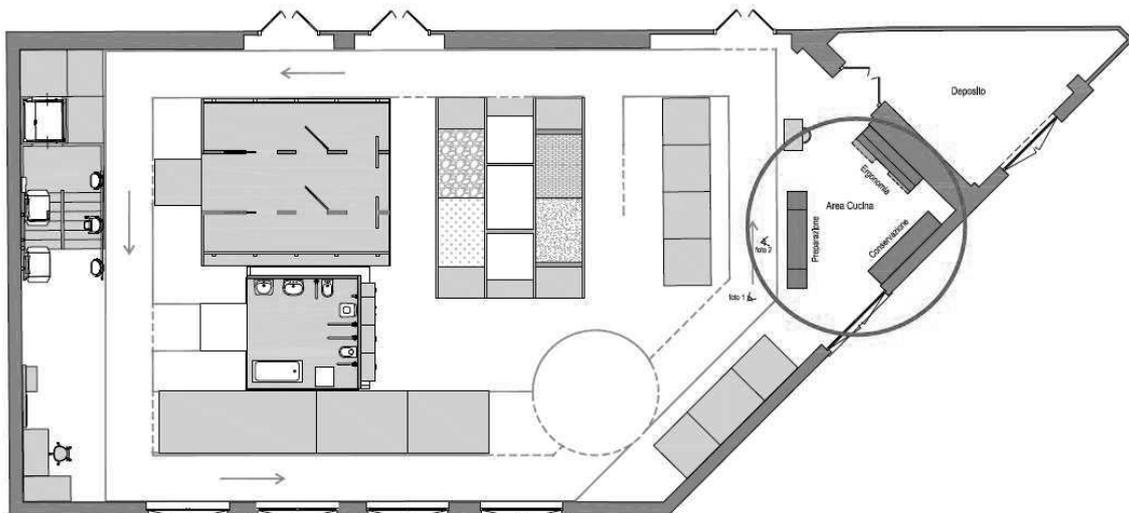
Planimetria Palestra di AUSILIA- Area Cucina
